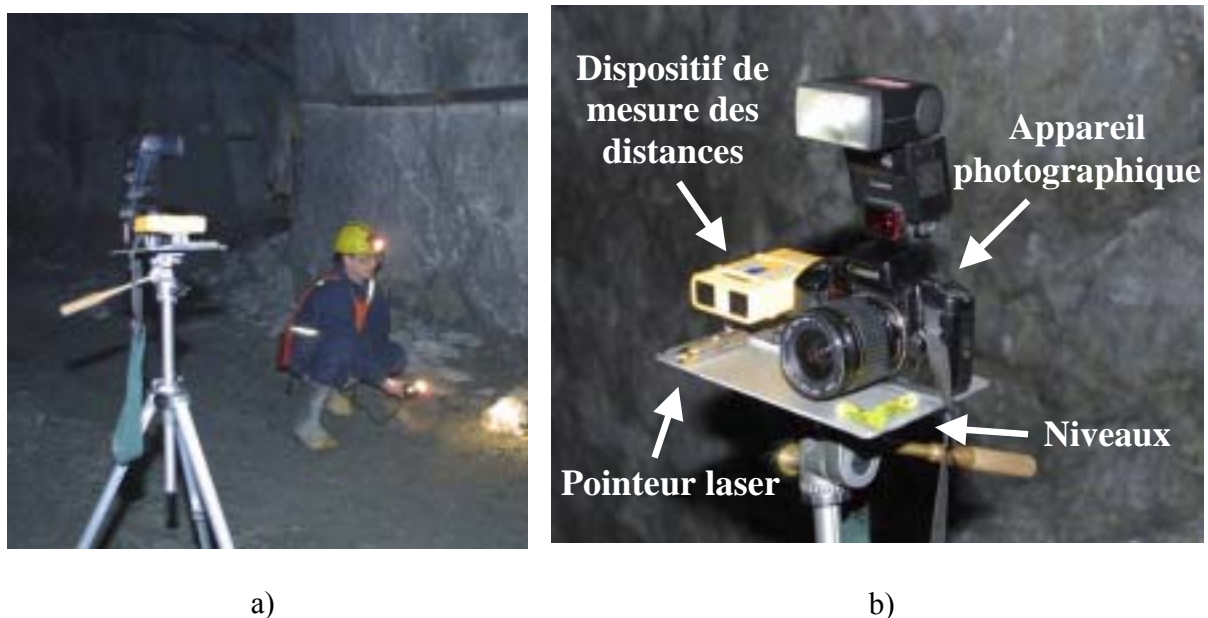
Système d'acquisition photographique. a) Vue d'ensemble; et b) plate-forme d'acquisition.
